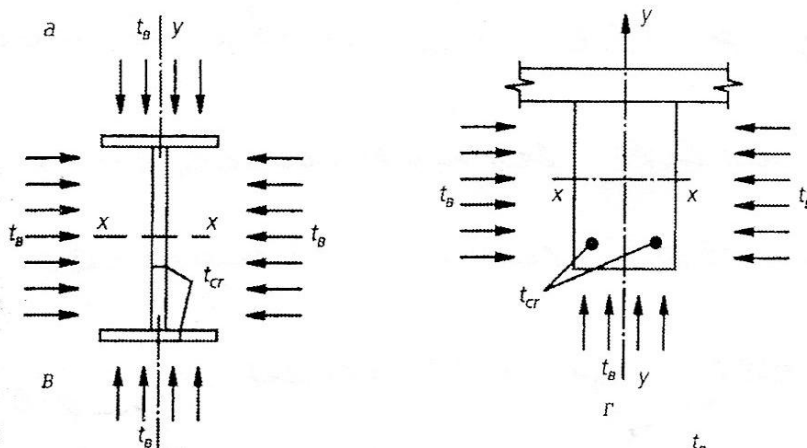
Расчетная схема 2 - по определению предела огнестойкости металлической и железобетонной балок
